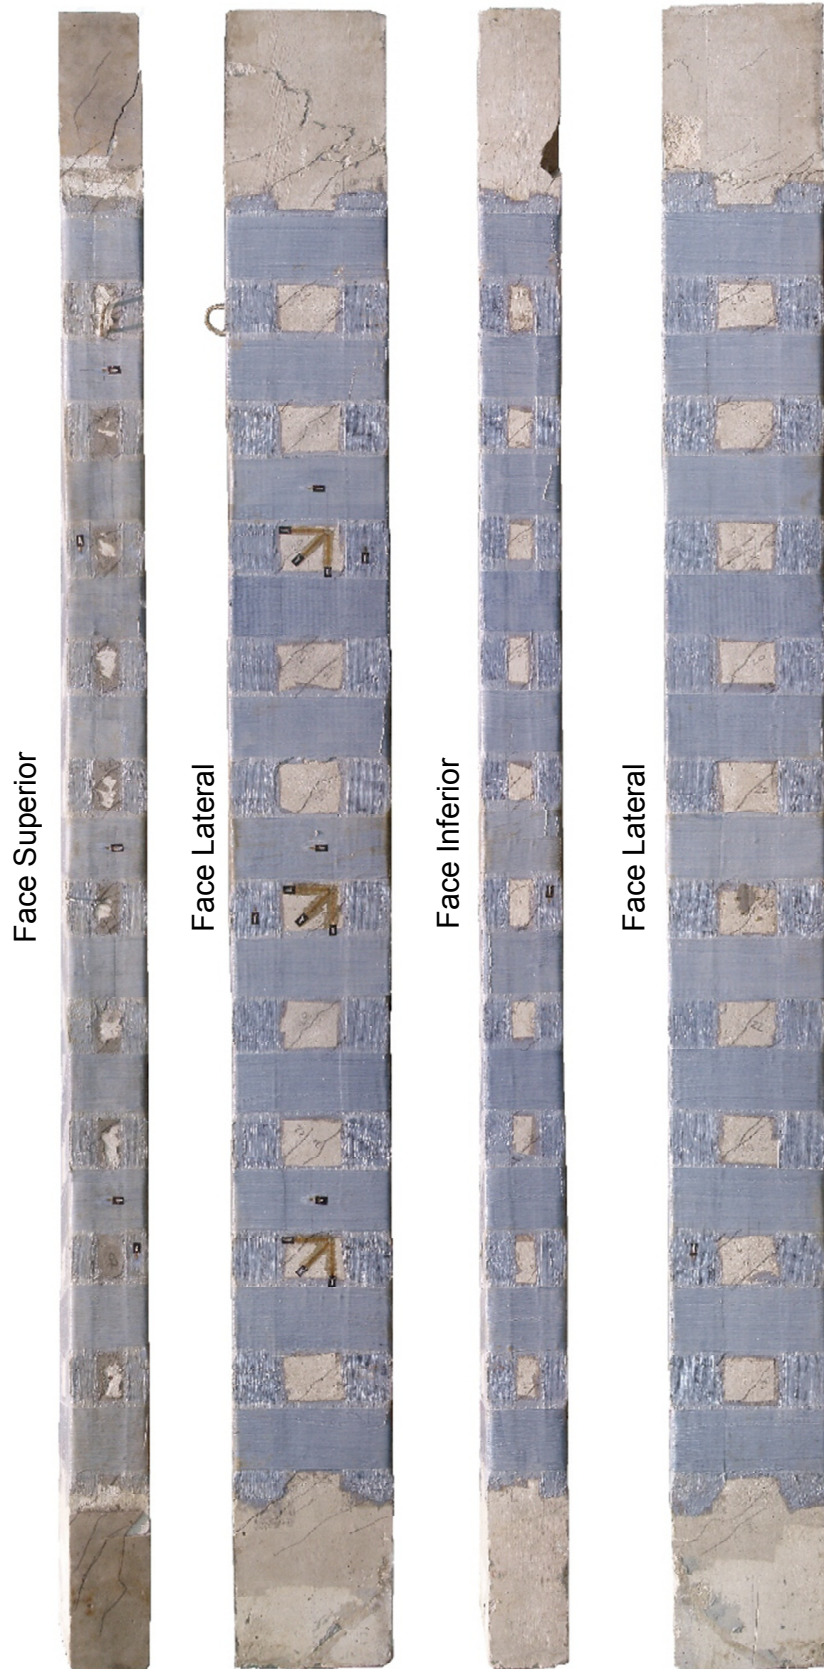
Configuração das fissuras da viga VTL2.
